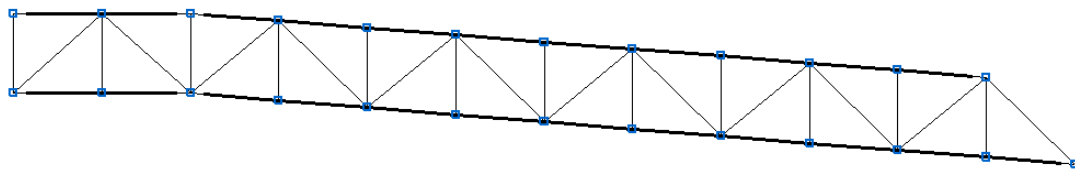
Vista de un plano 2D creado para facilitar el proceso constructivo
